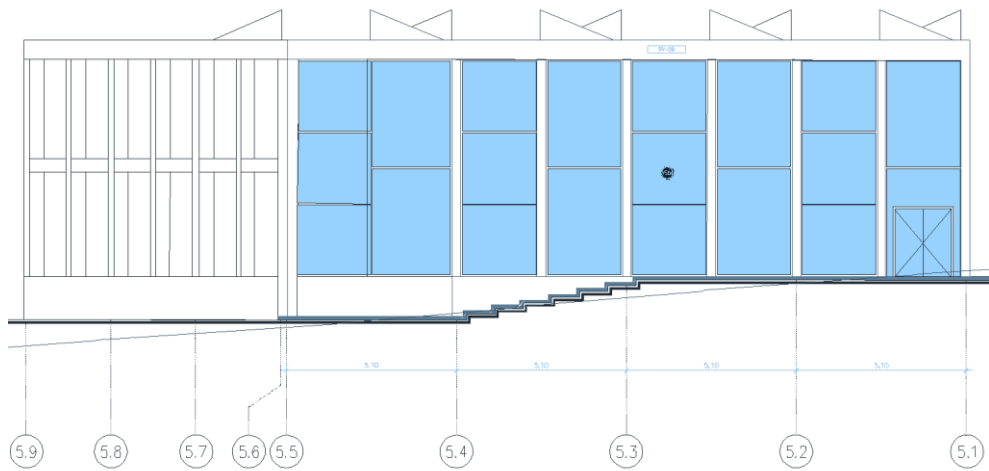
Plano Arquitectónico Elevación Sur Biblioteca [25]
